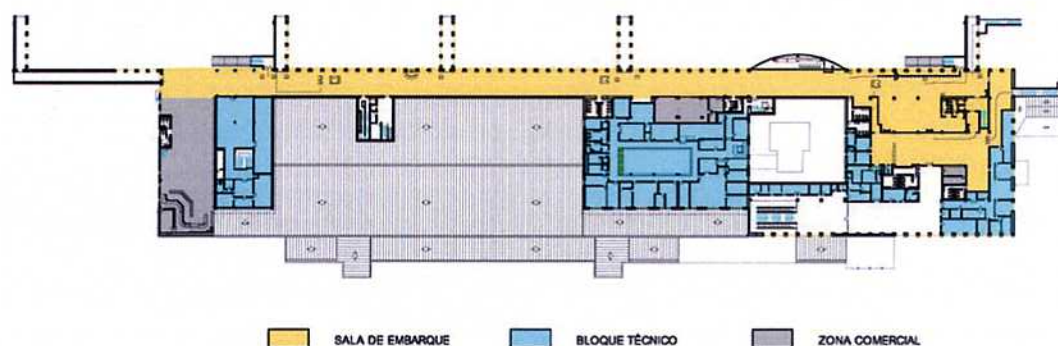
Ampliación de Edificio Terminal – Planta Baja
